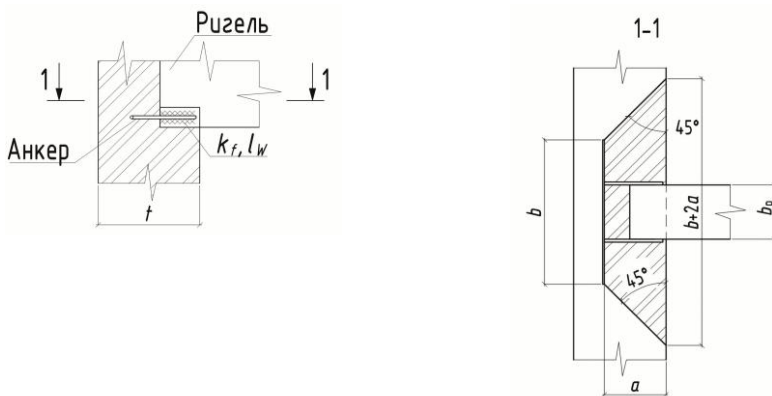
Анкерка кирпичной стены к ригелю перекрытия
